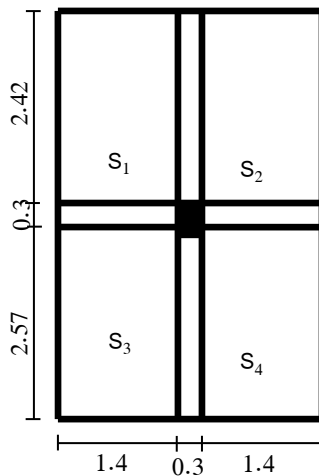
surface du plancher sur le poteau (poteau B-2)
